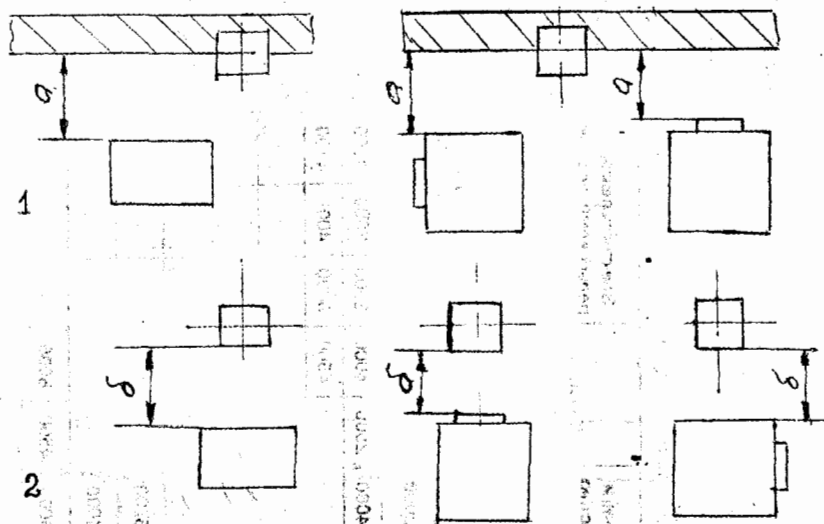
Расстояние от стен здания (1) и колонн (2) до оборудования
